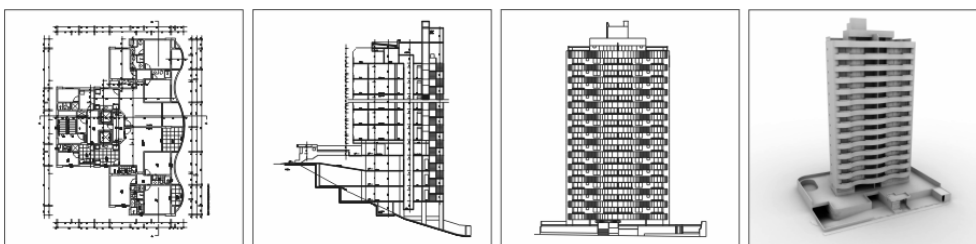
Planta baixa, corte, fachada e vista 3D de uma edificação a ser construída.
